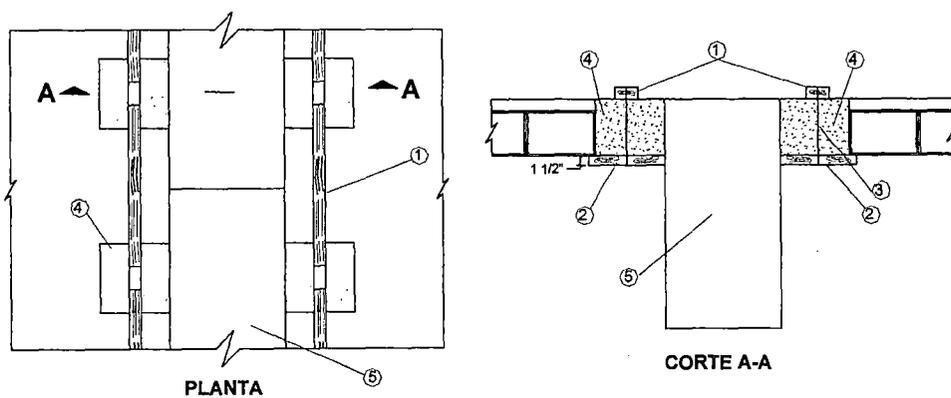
Picado del contrapiso para el ensanche de vigueta
